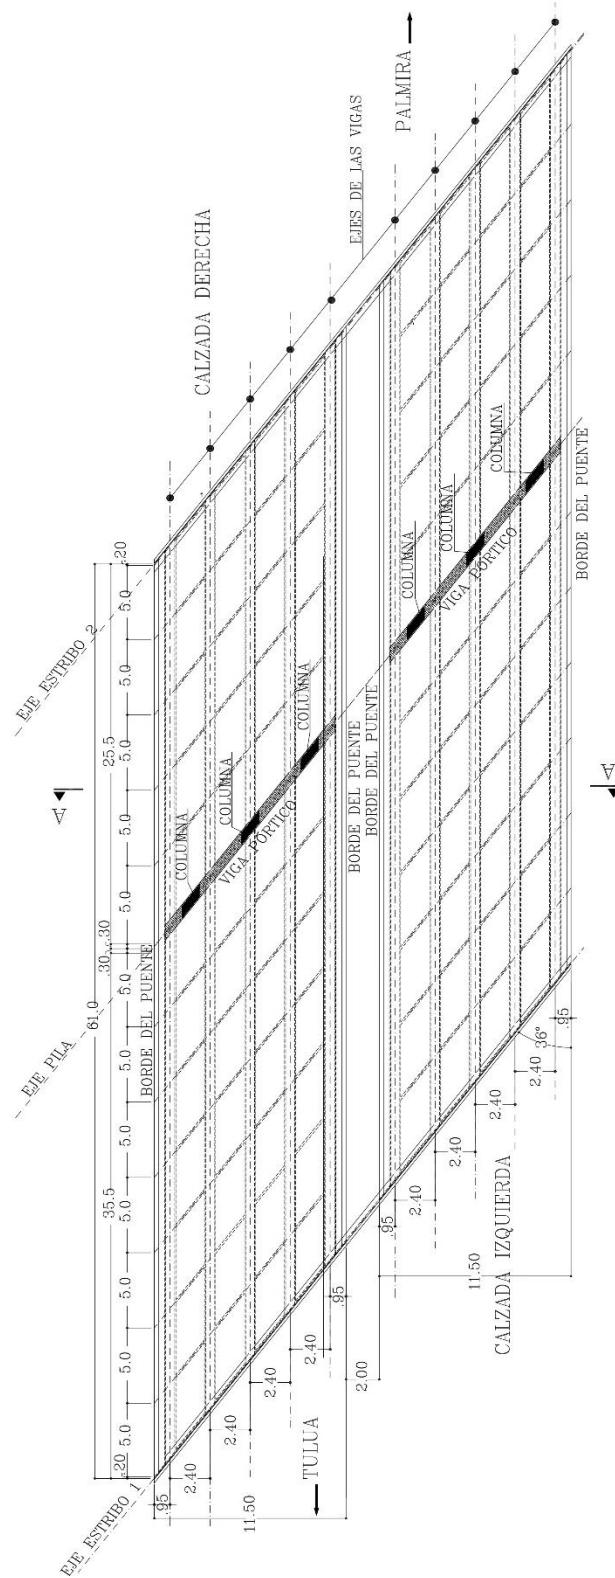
Distribución geométrica en planta de la superestructura del puente (información suministrada para chequeo estructural).
